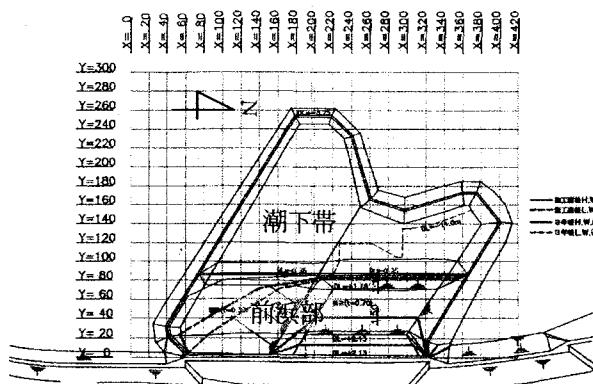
造成干潟平面図（施工直後：HWL以上0.4ha LWL以上1.6ha、全体5.4ha：面積は概数）
